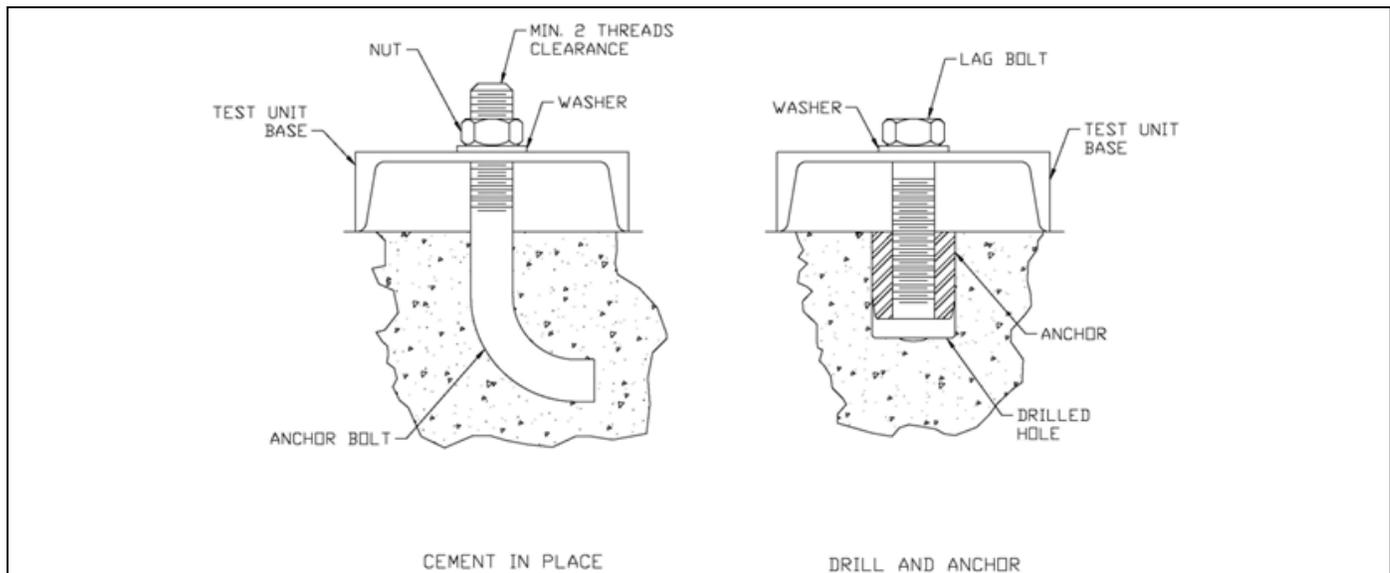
FIXATION DU BANC D'ESSAI
